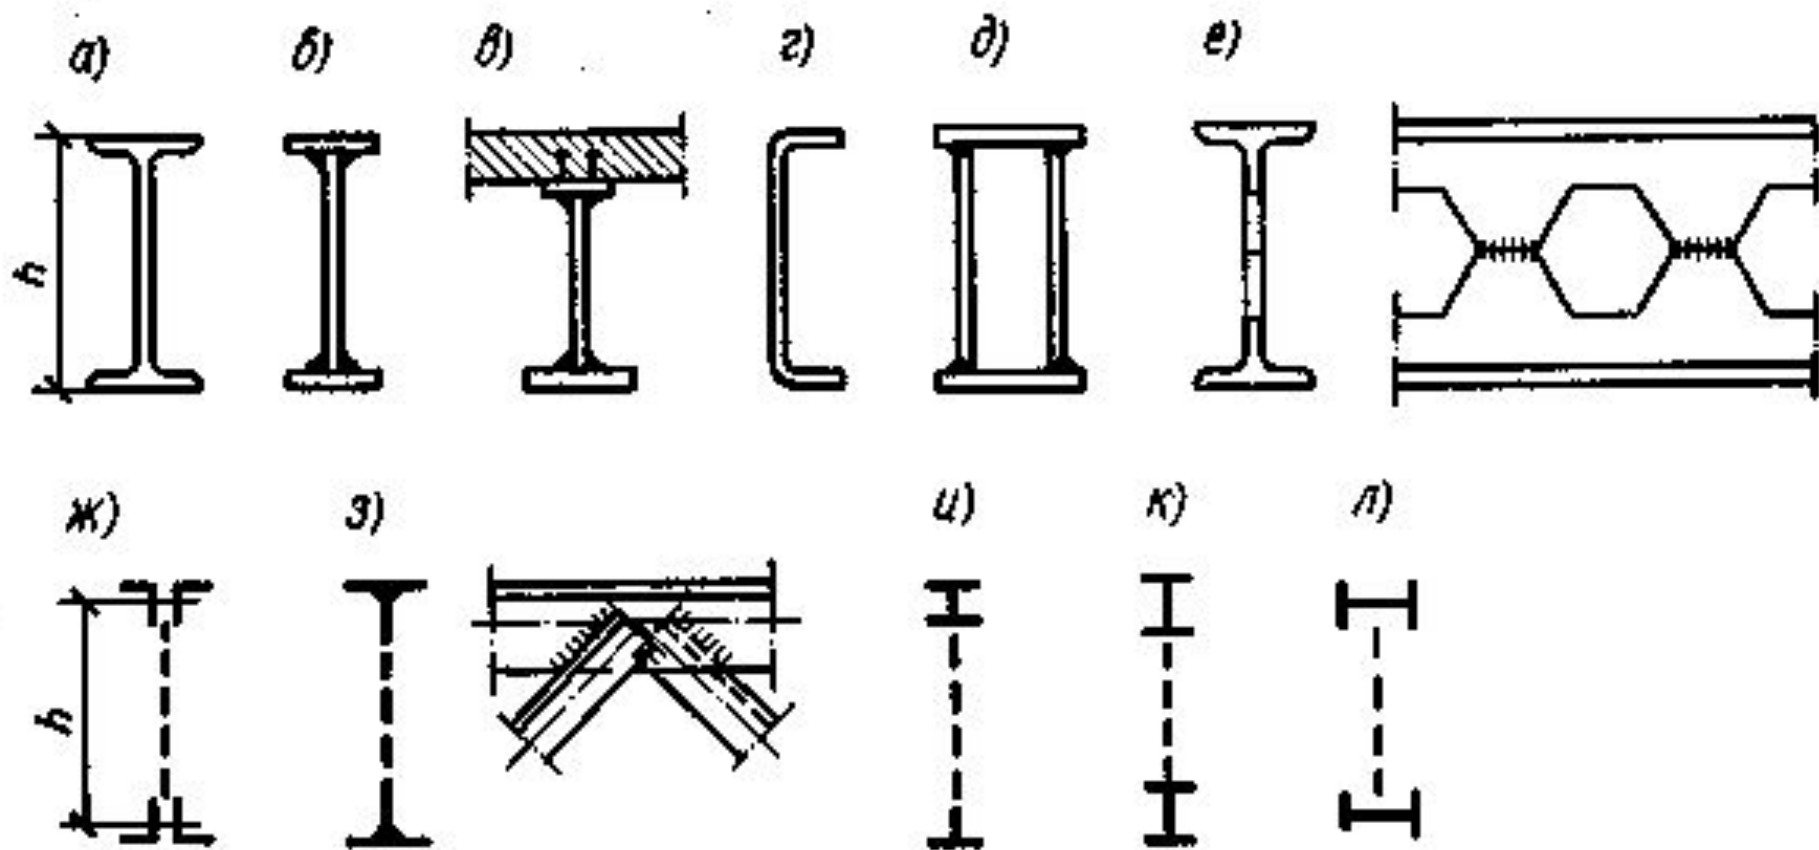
Сечения ригелей, балок и ферм перекрытий
